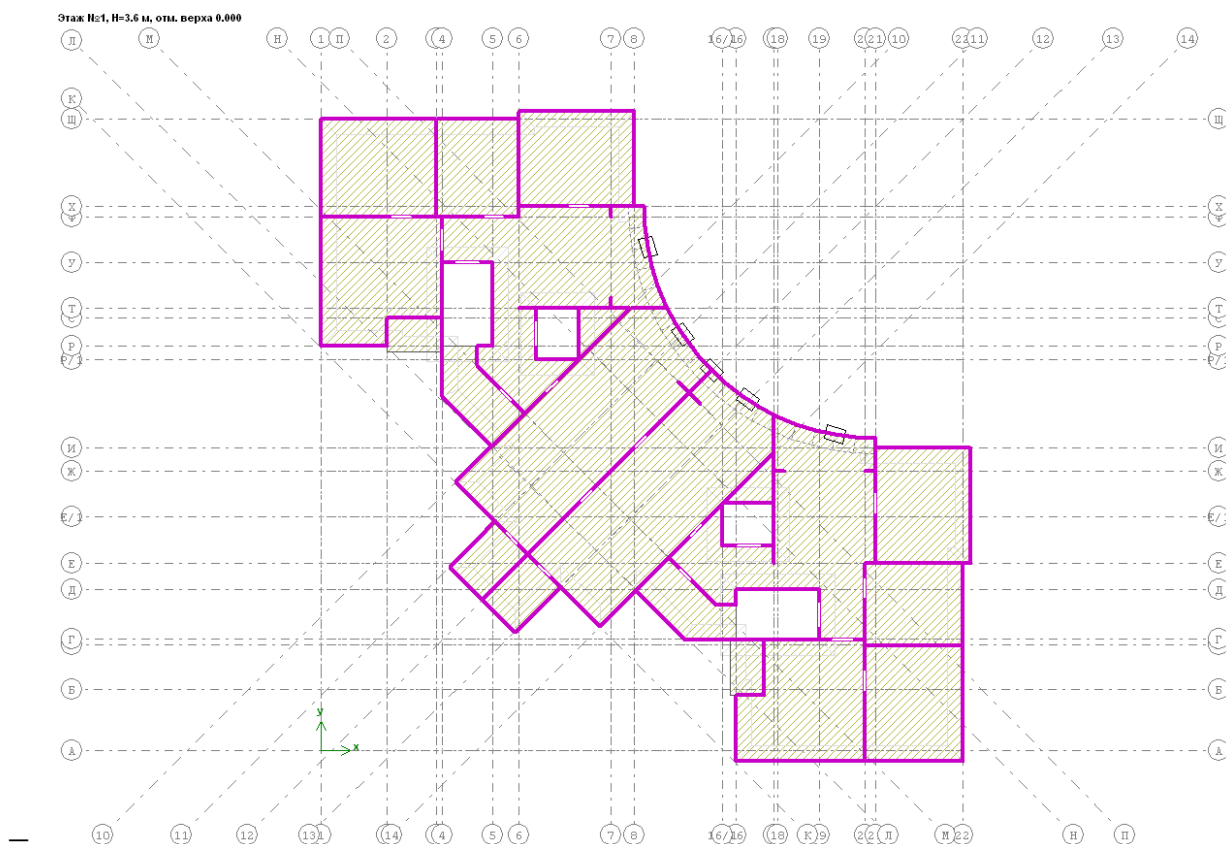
Розрахункова план-схема будівлі у ПК Мономах
